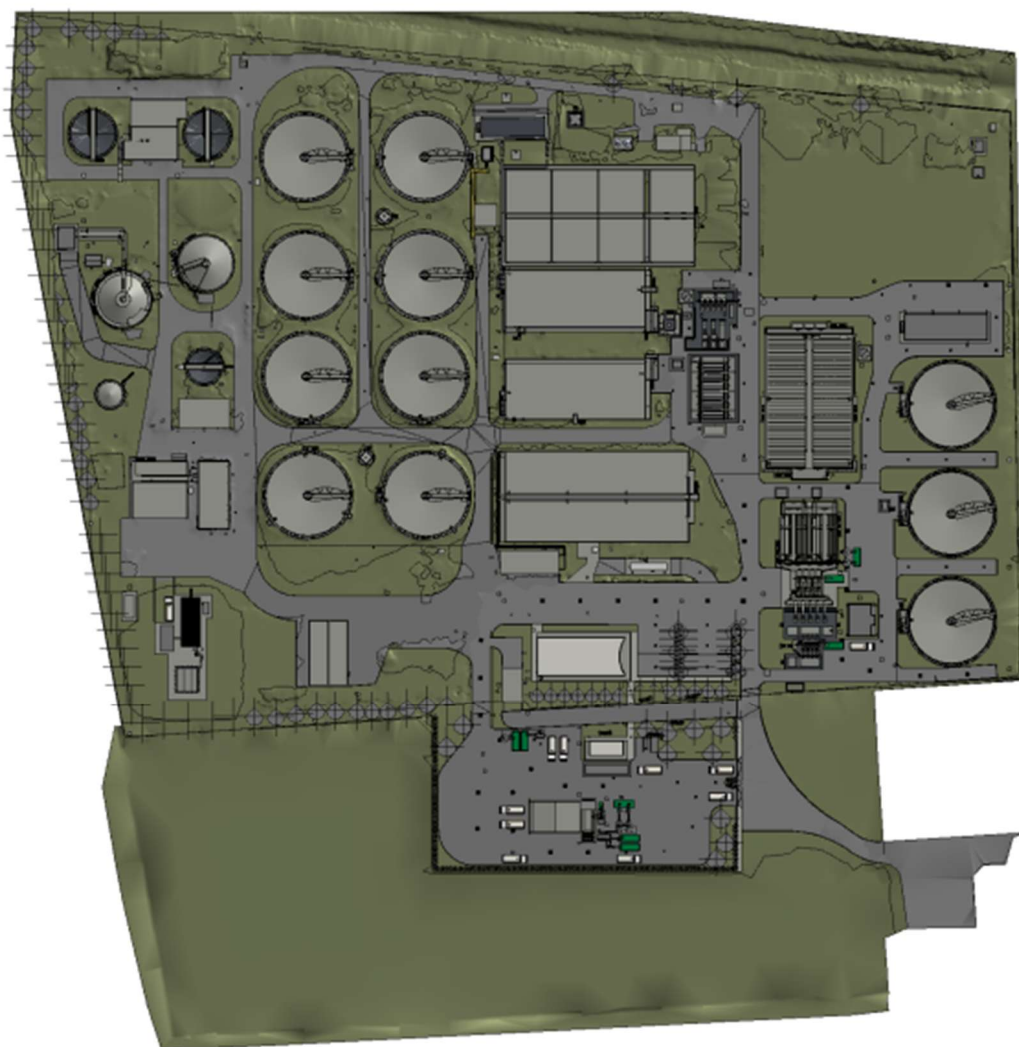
Layout stato di progetto impianto di depurazione di Ravenna
